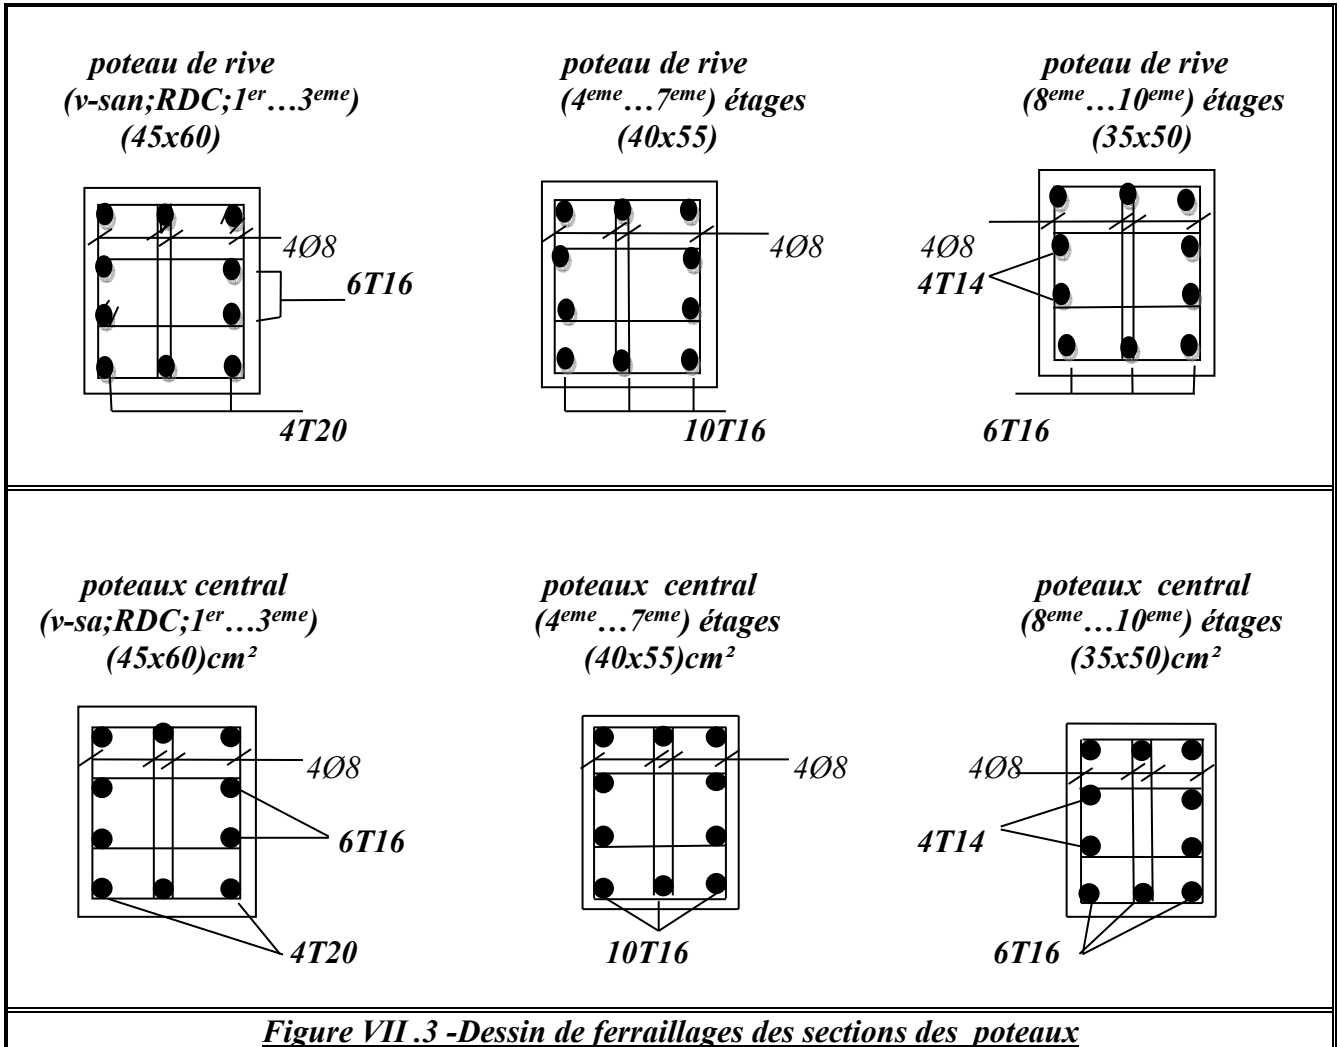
Dessin de ferrailages des sections des poteaux
